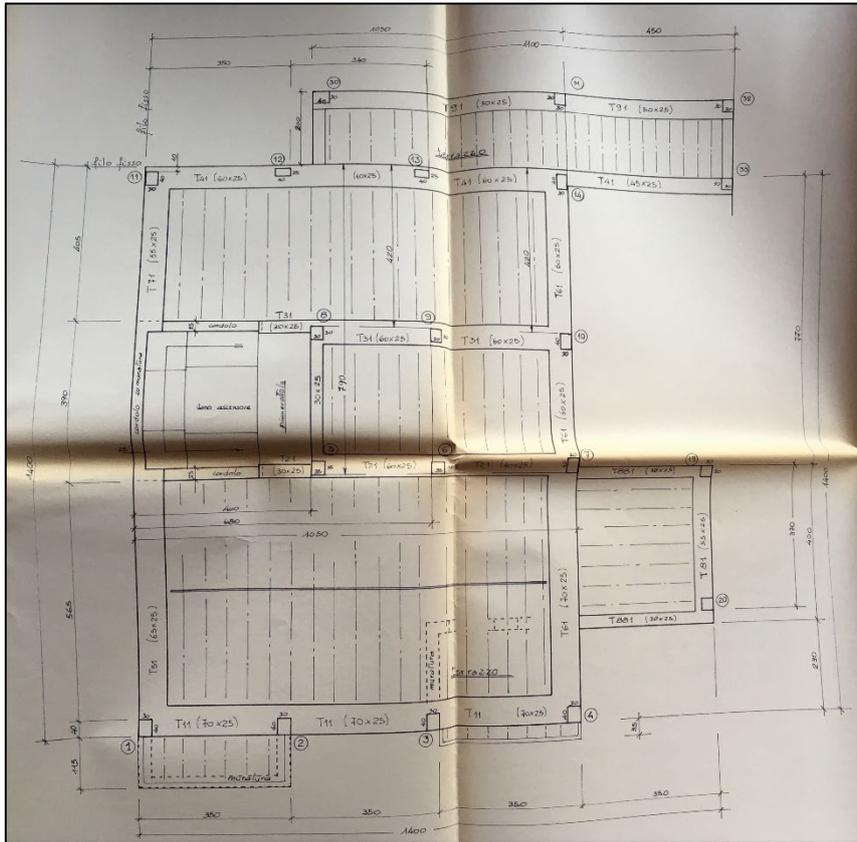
Pianta del secondo orizzontamento dei solai
